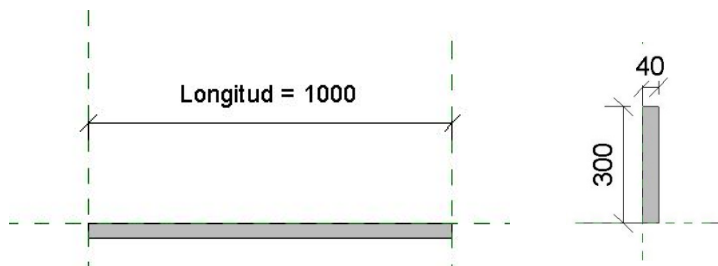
Planta y sección respectivamente de la geometría de costeros
